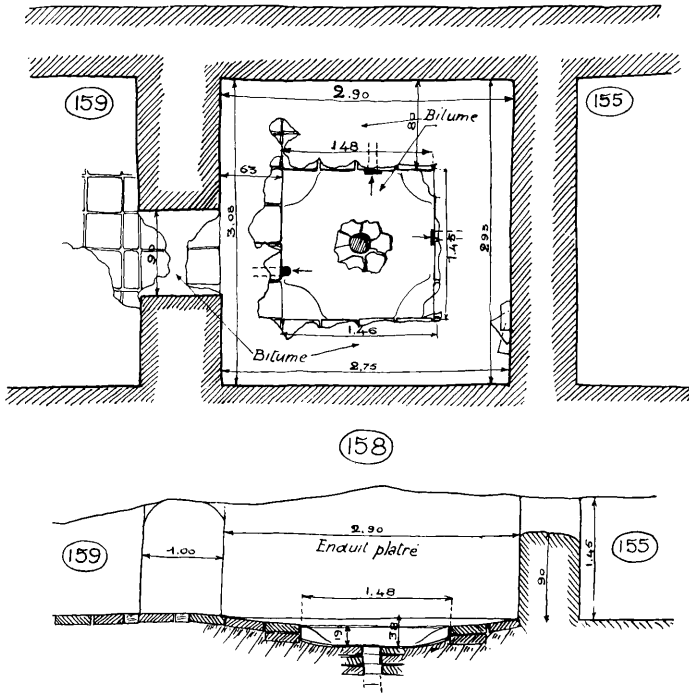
Salle d'eau 158. Détail de l'installation.
